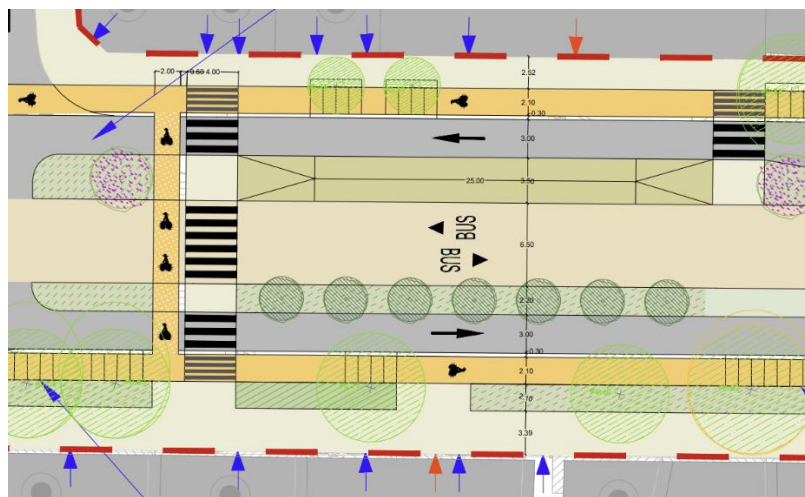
Tzen3 : Variante 1, station Ernest Renan
